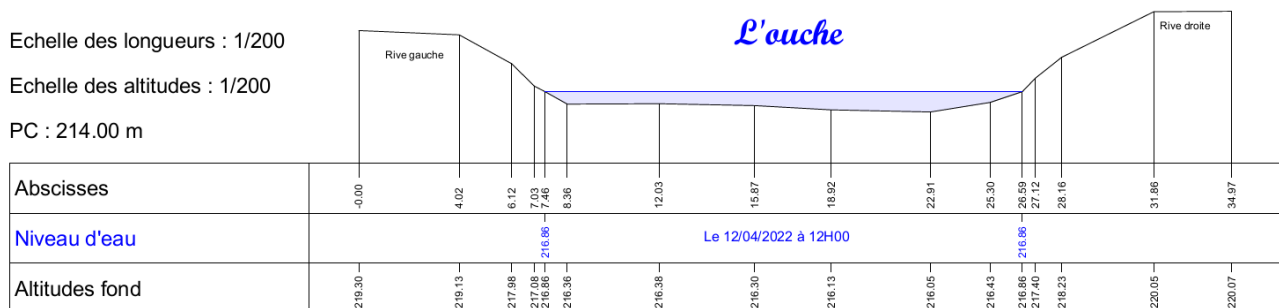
Profil en travers "type" de l'Ouche au droit du site d'étude
